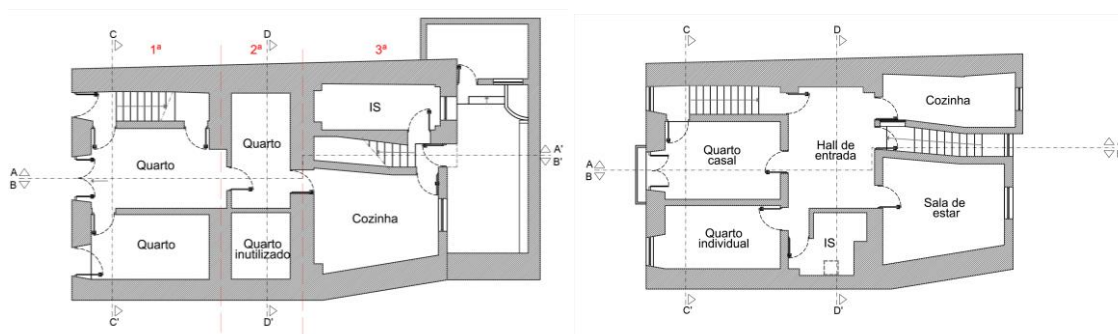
Planta existente, piso 0 e piso 1, respetivamente.
